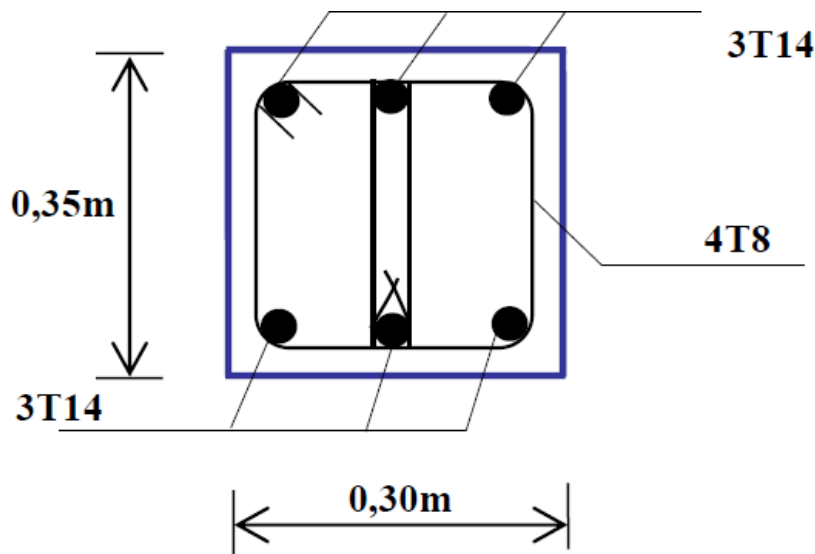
5: Croquée de ferrailage de la poutre brisée
